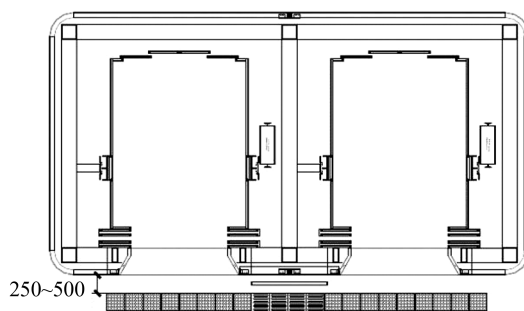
并置电梯前提示盲道示意图 (单位: mm)
